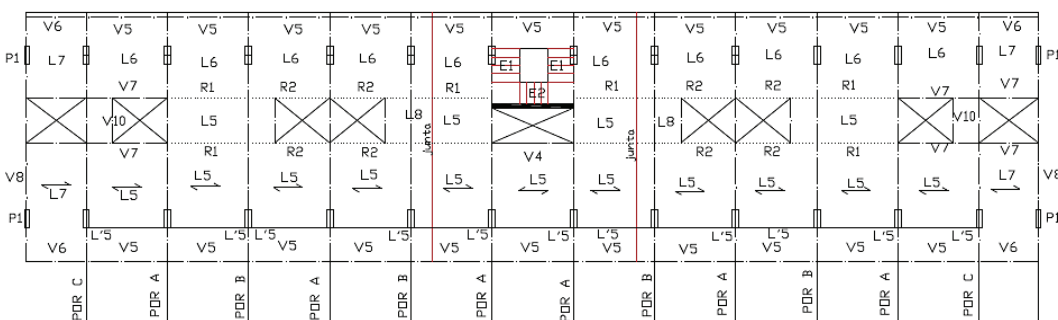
Planta Estrutural do piso superior tipo (2º, 4º, 6º e 8º) [26].
